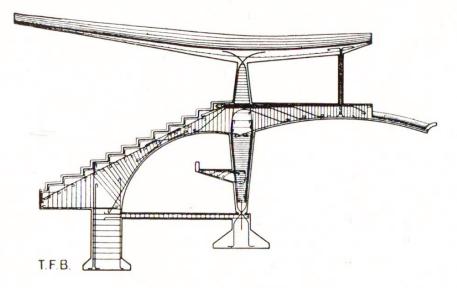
Tribunes du champ de course à Madrid. En bas: coupe transversale de la construction en béton armé.
